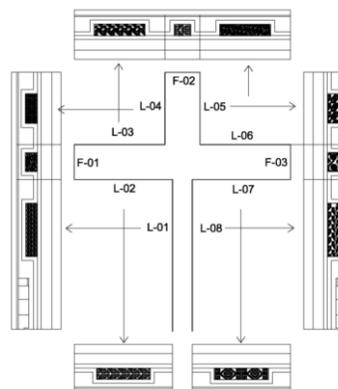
Planta Arquitectónica de la tumba con nomenclatura
